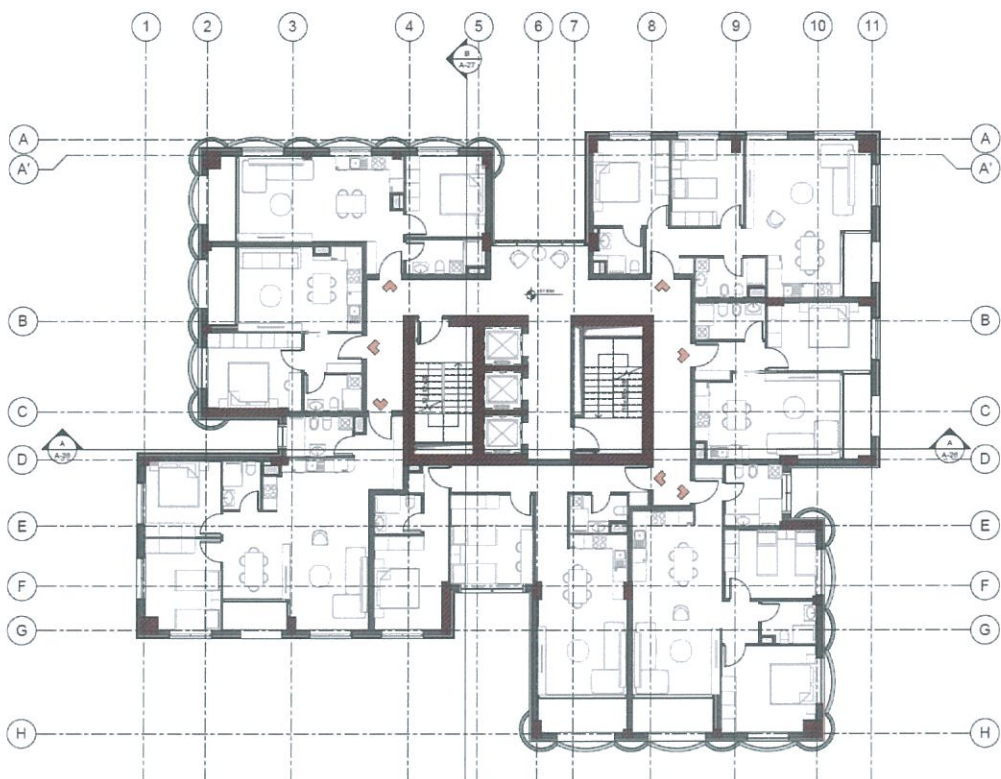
Plani i Katit +8 – Banim, Kuota +31.68
